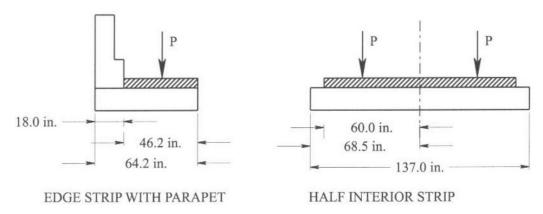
Comparación de tiras de borde longitudinal
